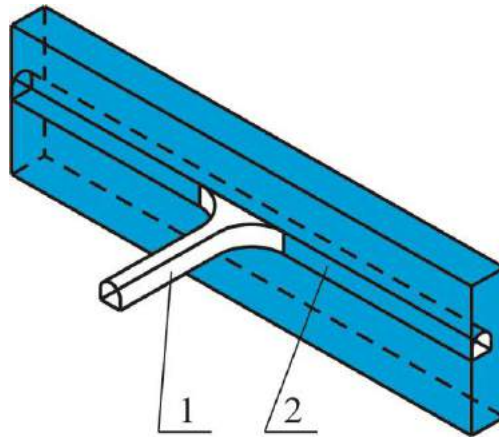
Схема підготовки рудним штреком: 1 – квершлаг; 2 – рудний штрек
